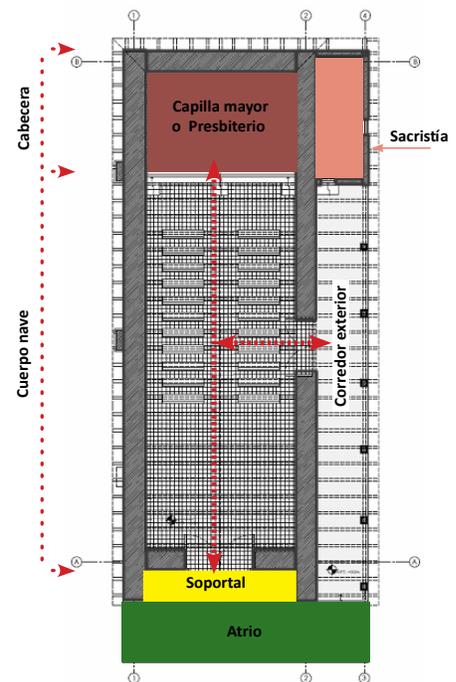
Esquema planta Capilla de Huenchullamí.
